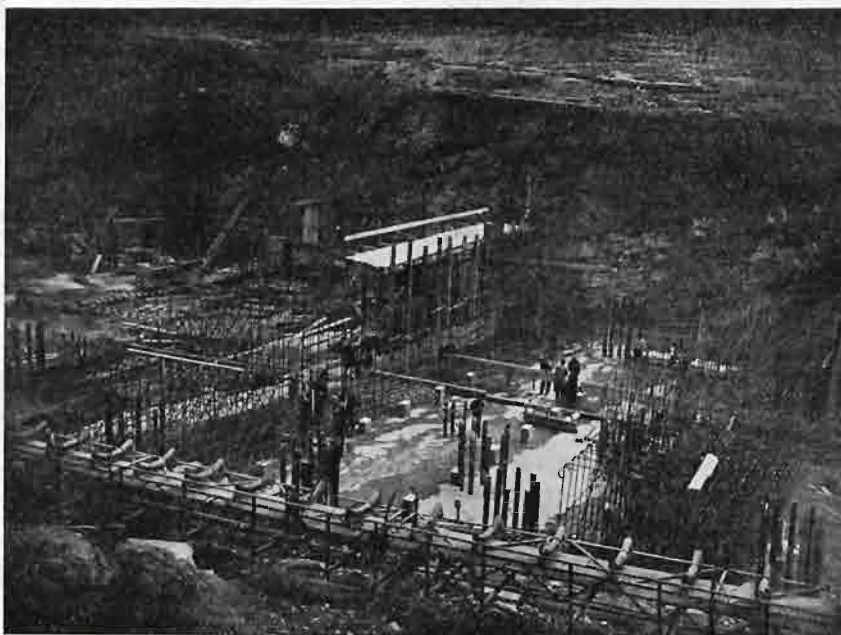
Schemat uzbrojenia belek fundamentowych.
